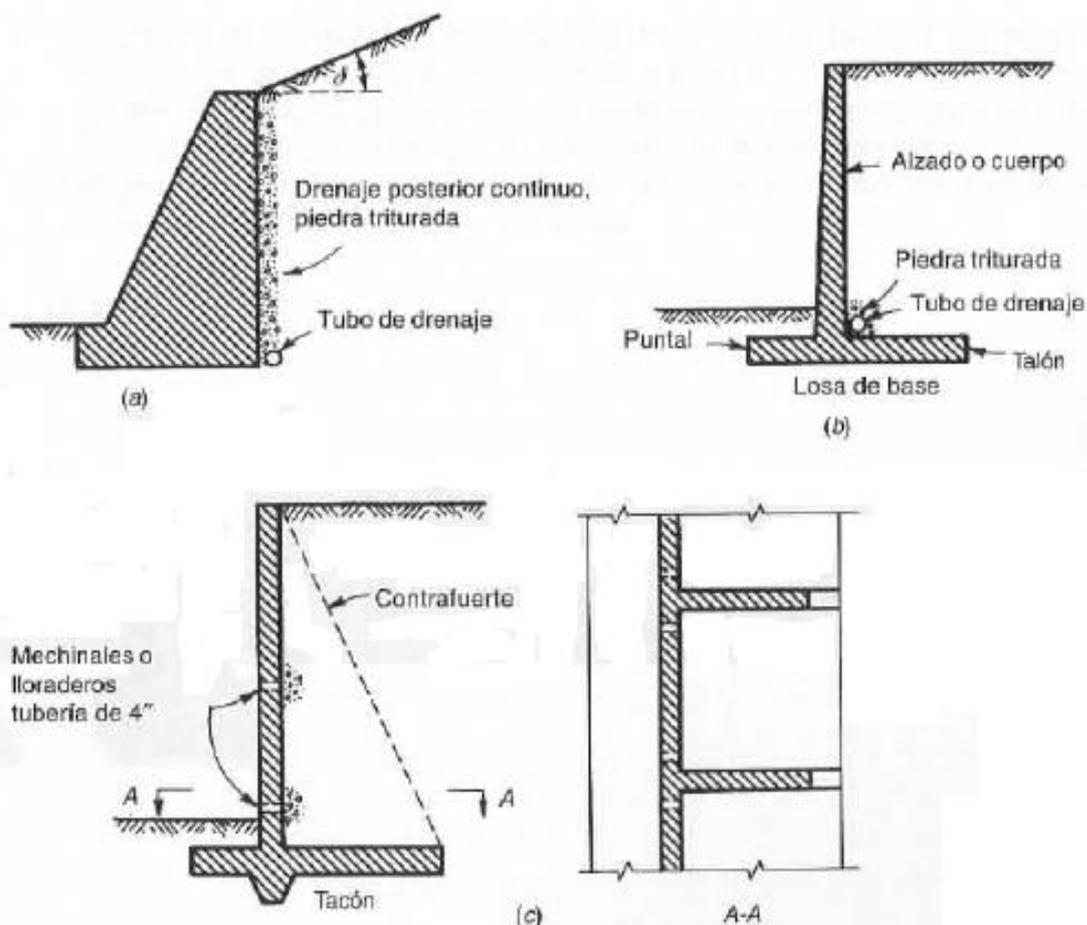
Tipos de muro de contención y drenaje. a) muro de gravedad, b) muro en voladizo, c) muro con contrafuertes
